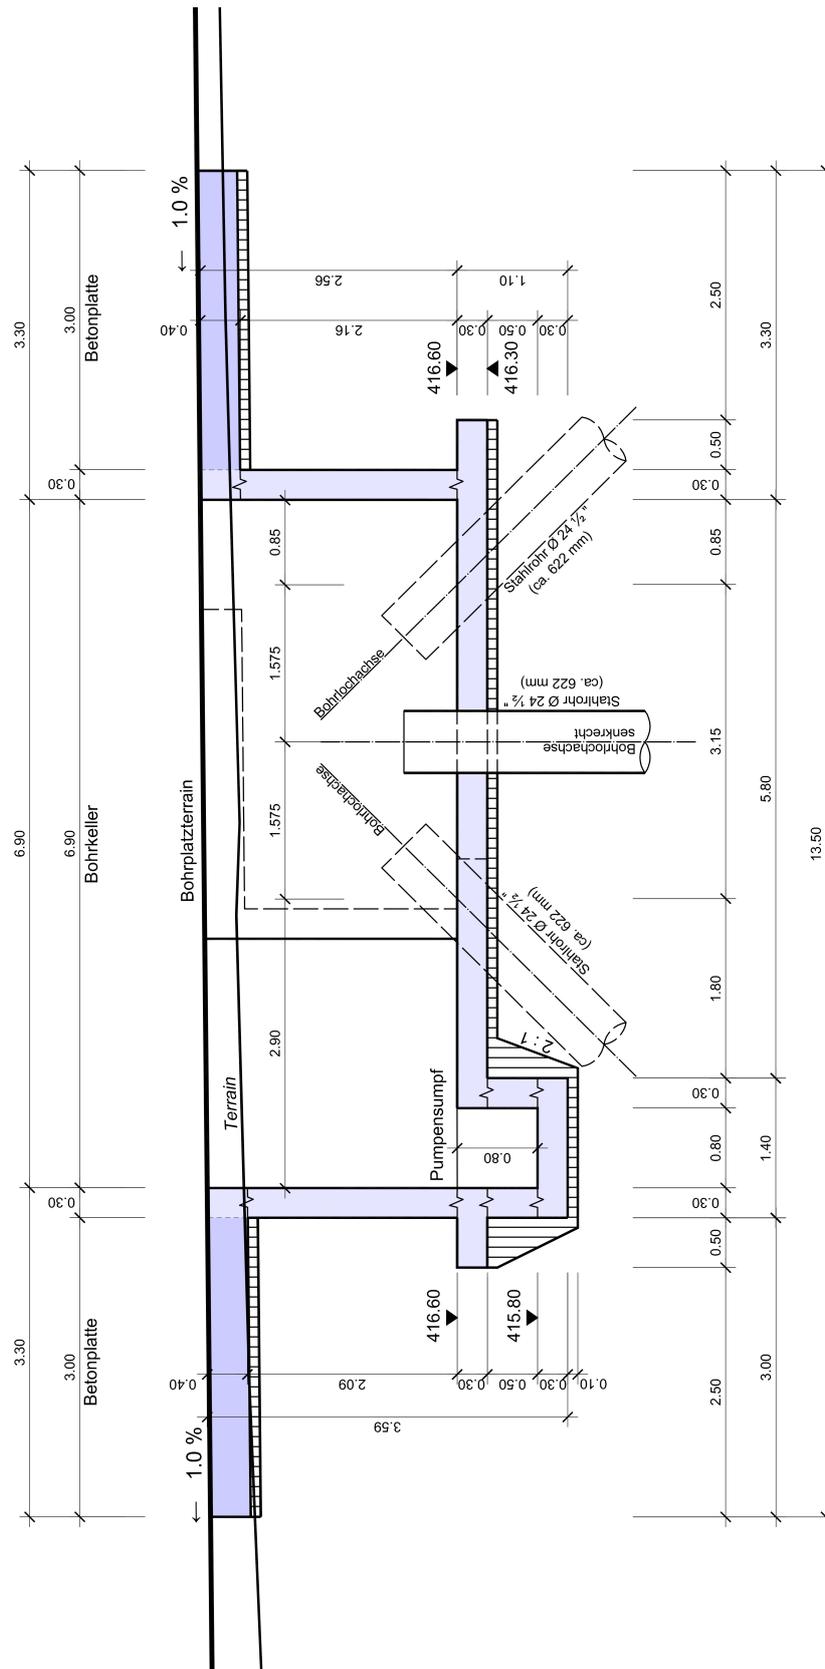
Längsschnitt (B-B) des Bohrkellers mit den Bohrrichtungen WNW und ESE und den entsprechenden Bohransatzpunkten (Lage des Schnitts vgl. Beilage 8).
